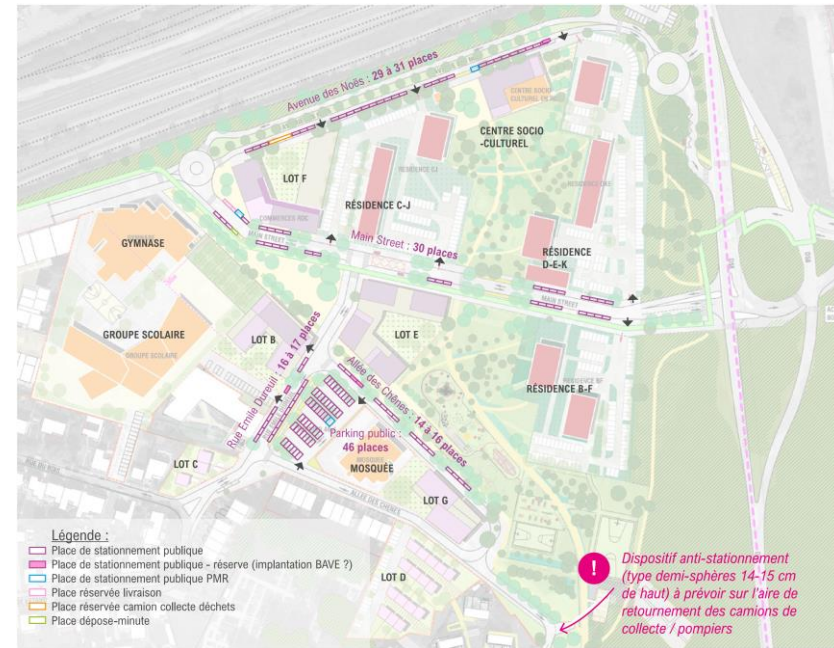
Plan du stationnement public au sein du périmètre du projet (Source : La Fabrique Urbaine, Plan guide, 06/2024)
